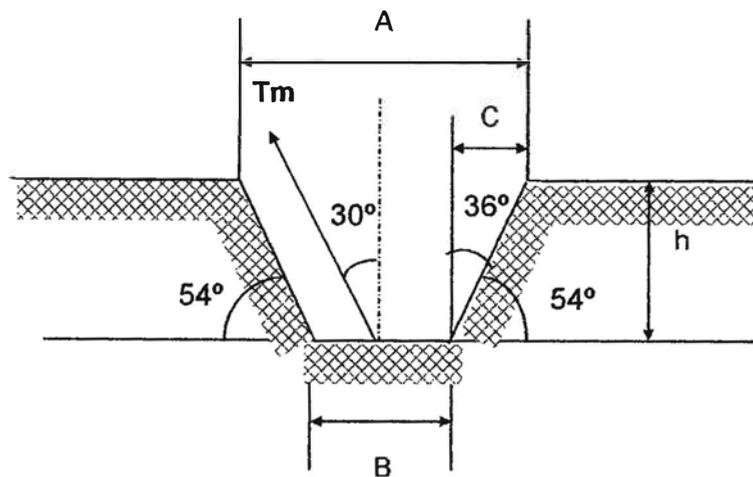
Detalle de bloque de concreto (retenidas)
